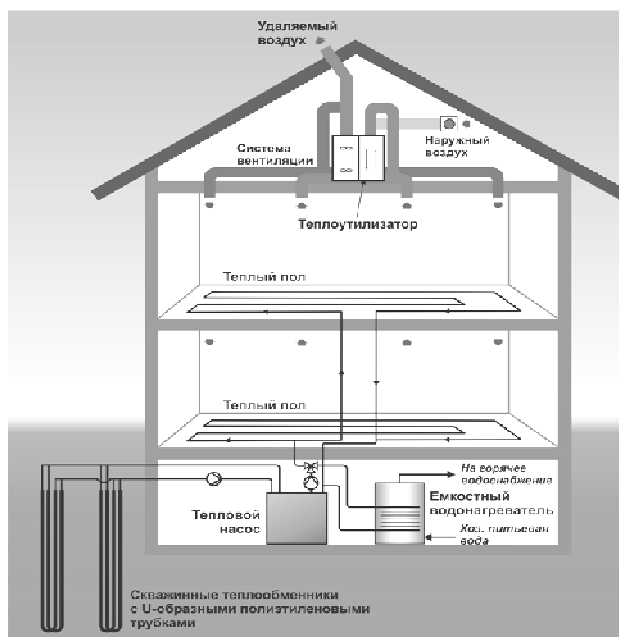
Схема энергообеспечения жилого дома с использованием тепла грунта и тепловых выбросов вентиляции (режим отопления 45-35 °С, после отопительного сезона скважинные теплообменники используются для охлаждения помещений)
